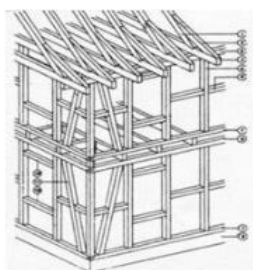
Esquema de uma estrutura em “gaiola” [5]
